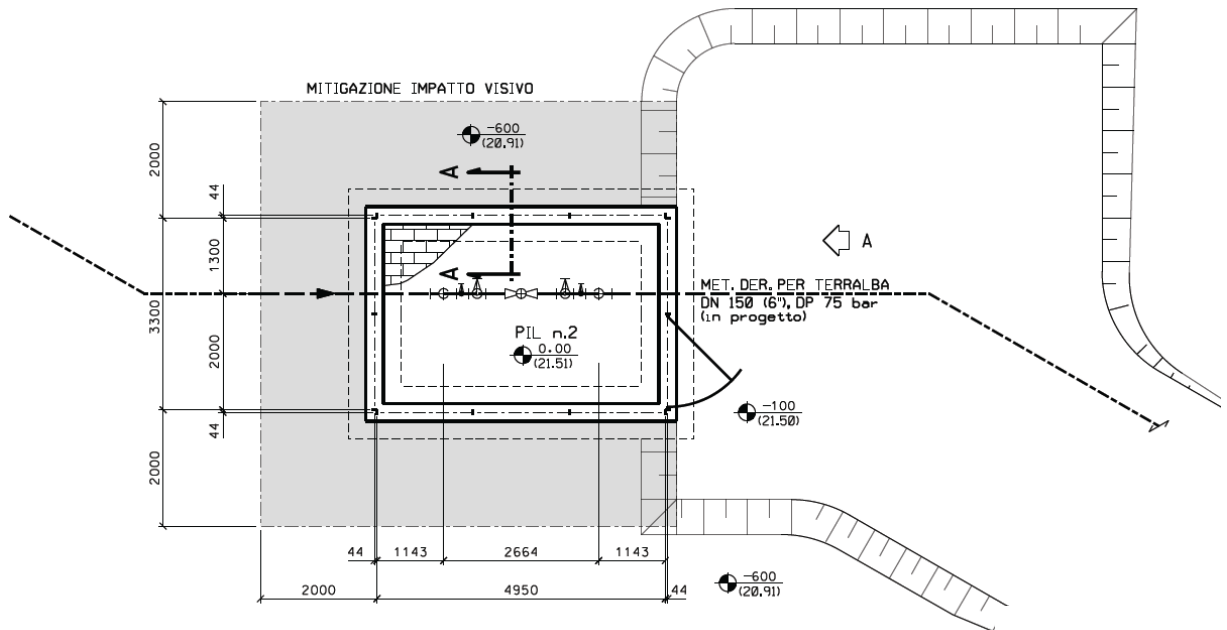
Inquadramento planimetrico delle opere in progetto.
